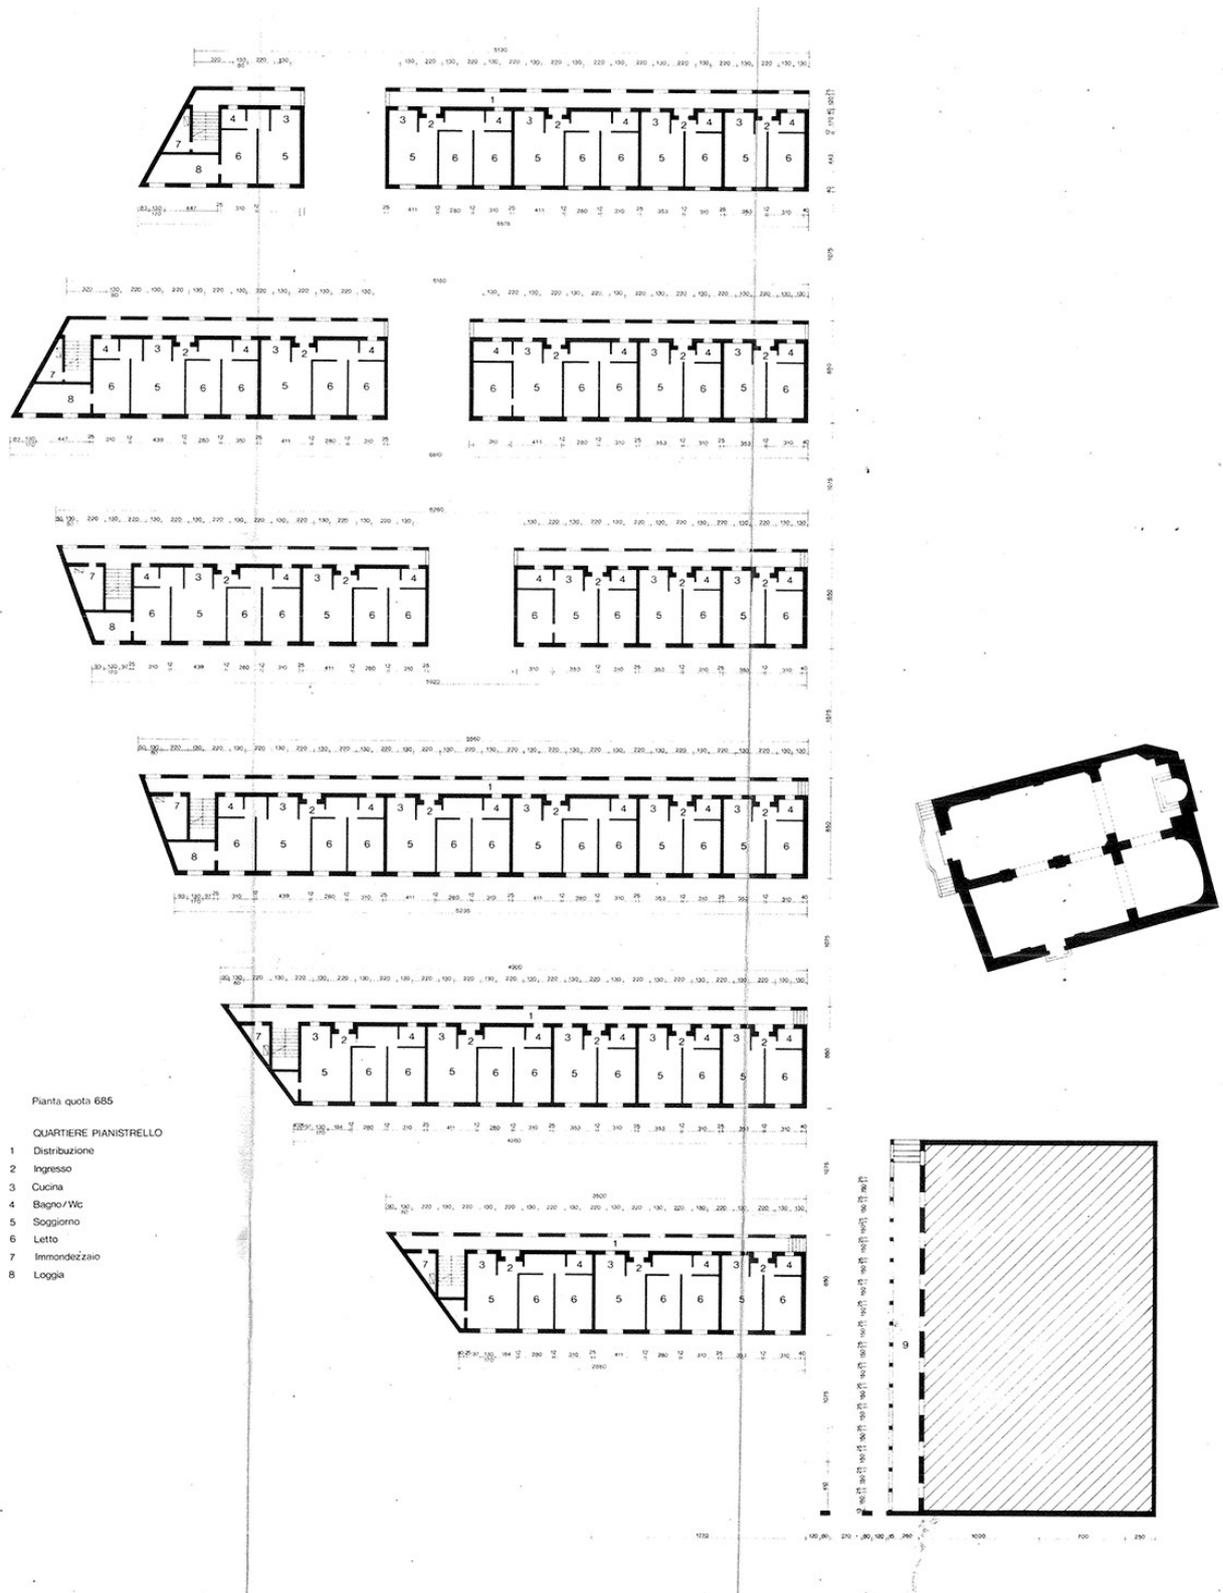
Piano di Recupero di Teora: progetto del quartiere Pianistrello (pianta a quota 685).
